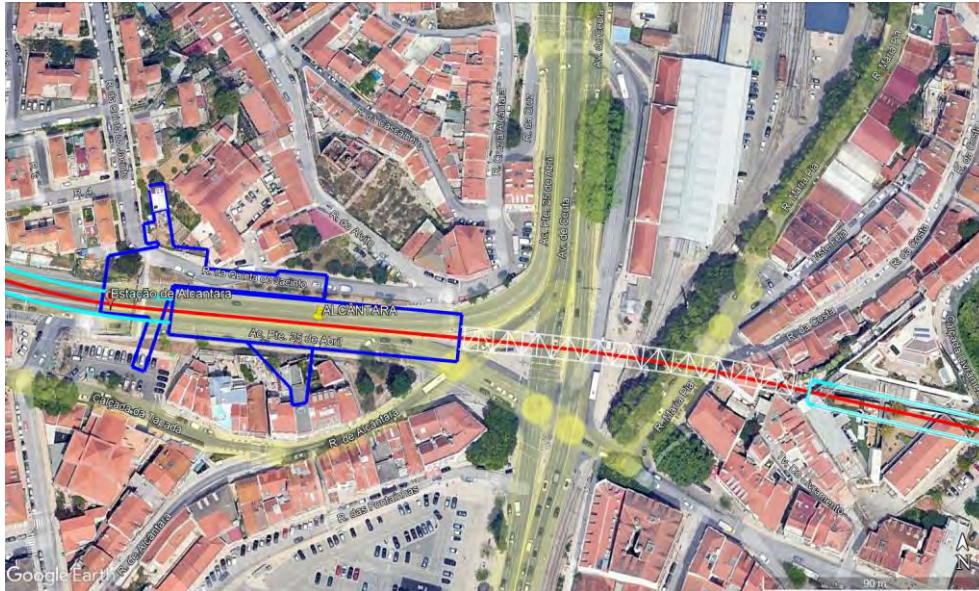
Ortofoto da área de construção da futura Estação de Alcântara e viaduto de ligação.
